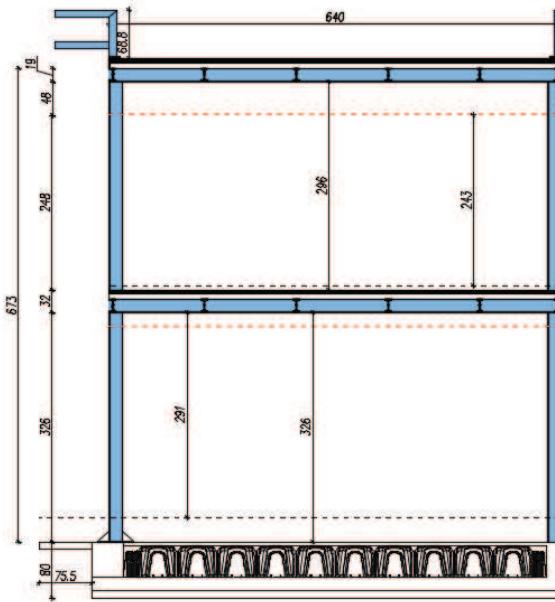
piante e sezioni del reale edificio oggetto di studio (acciaio)
